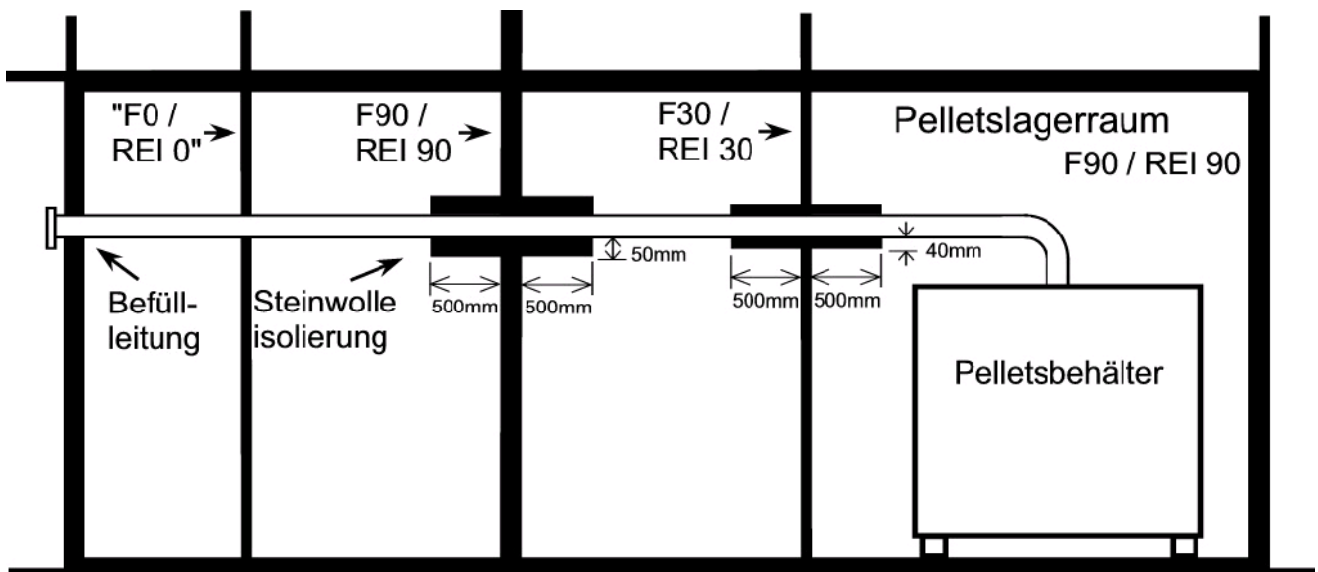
Ausführungsbeispiel einer Befüllleitung (Stahlrohr $< DN 150$) welche durch brandabschnittsbildende Bauteile geführt wird.
